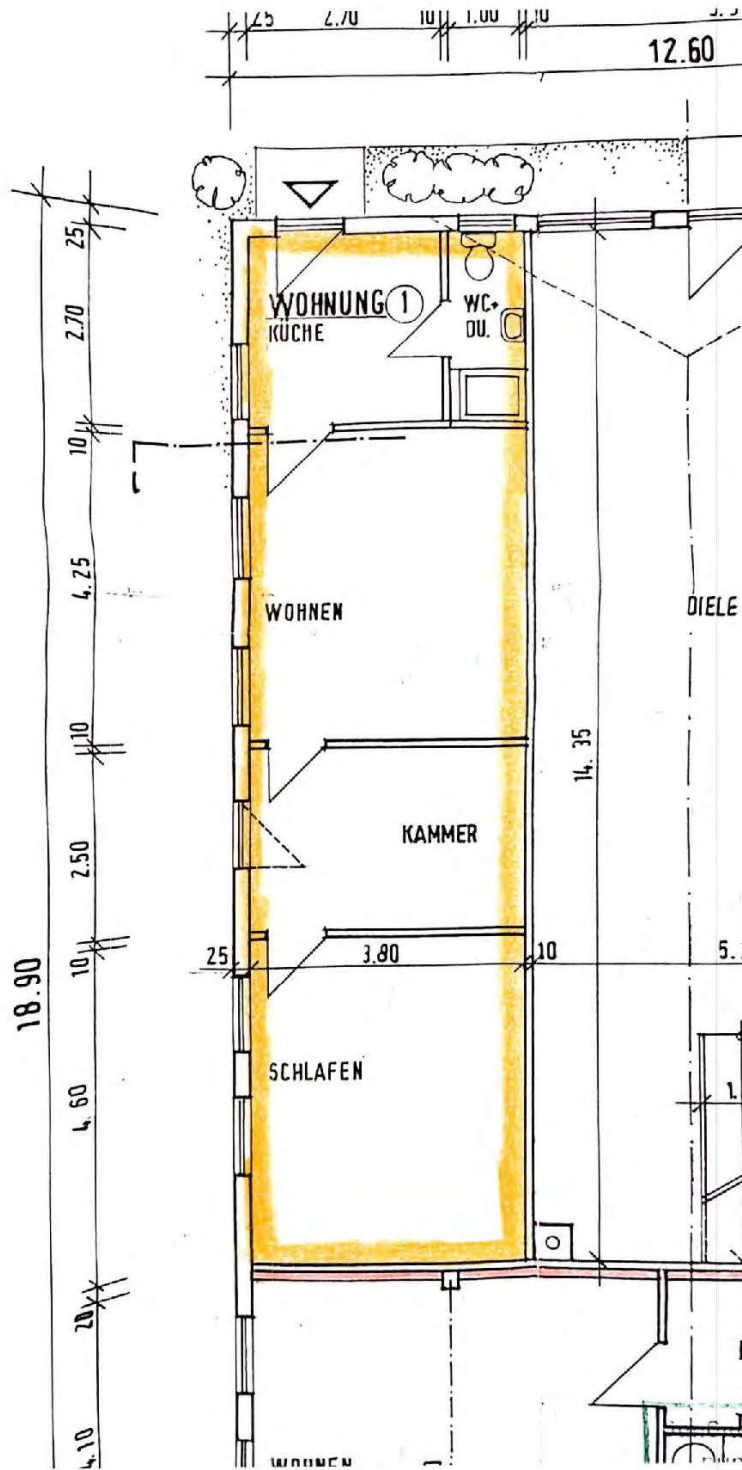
Grundriss EG mit Kennzeichnung Wohnungen sowie Waschküche und Abstellbereich
